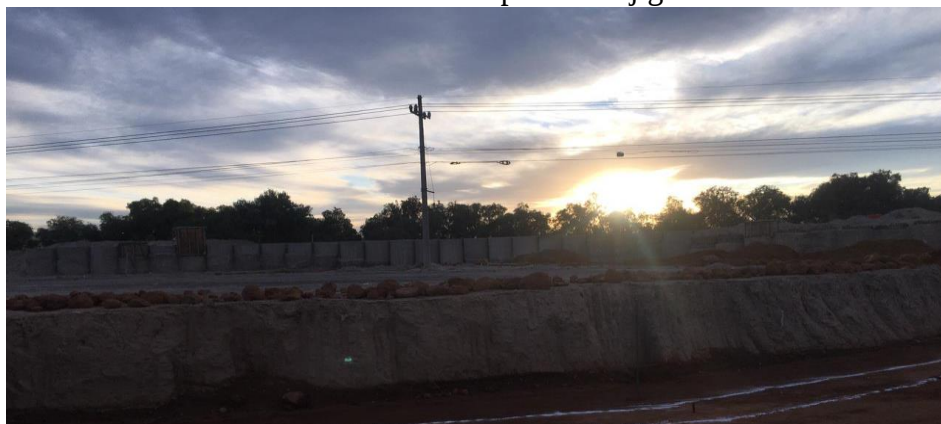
NOTA: Adaptado de Pilas tangentes, Autoría Propia, 2023
